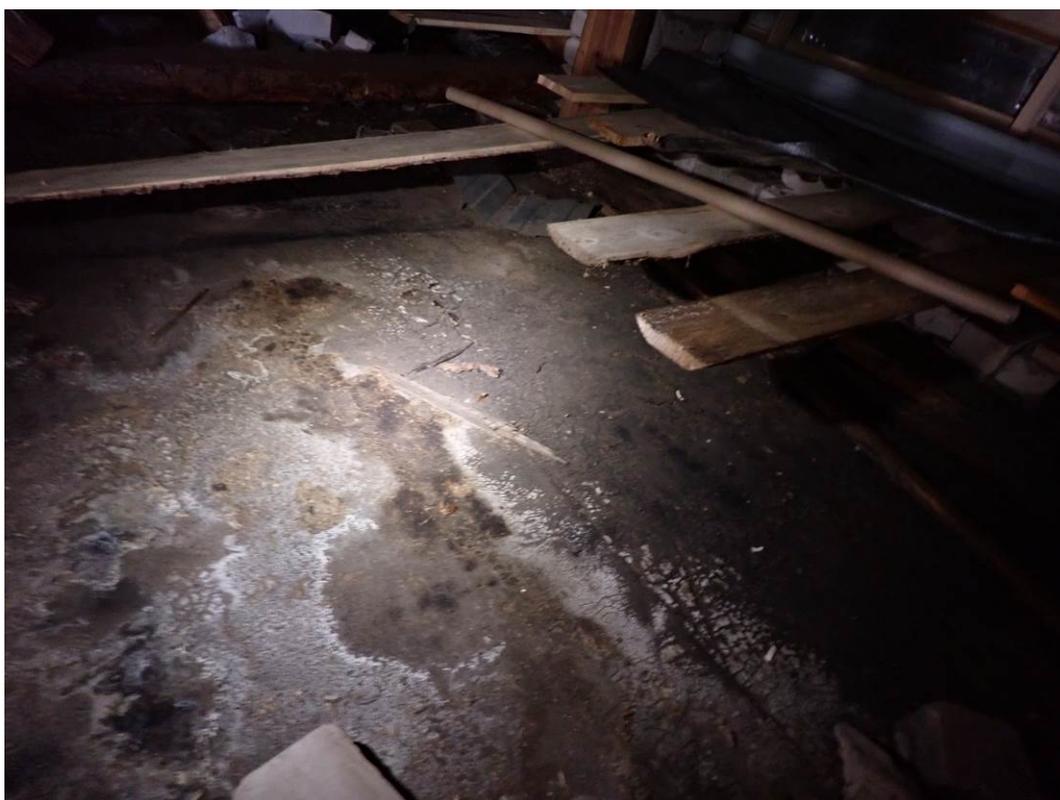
Следы замачивания плит чердачного перекрытия со стороны чердачного помещения.
